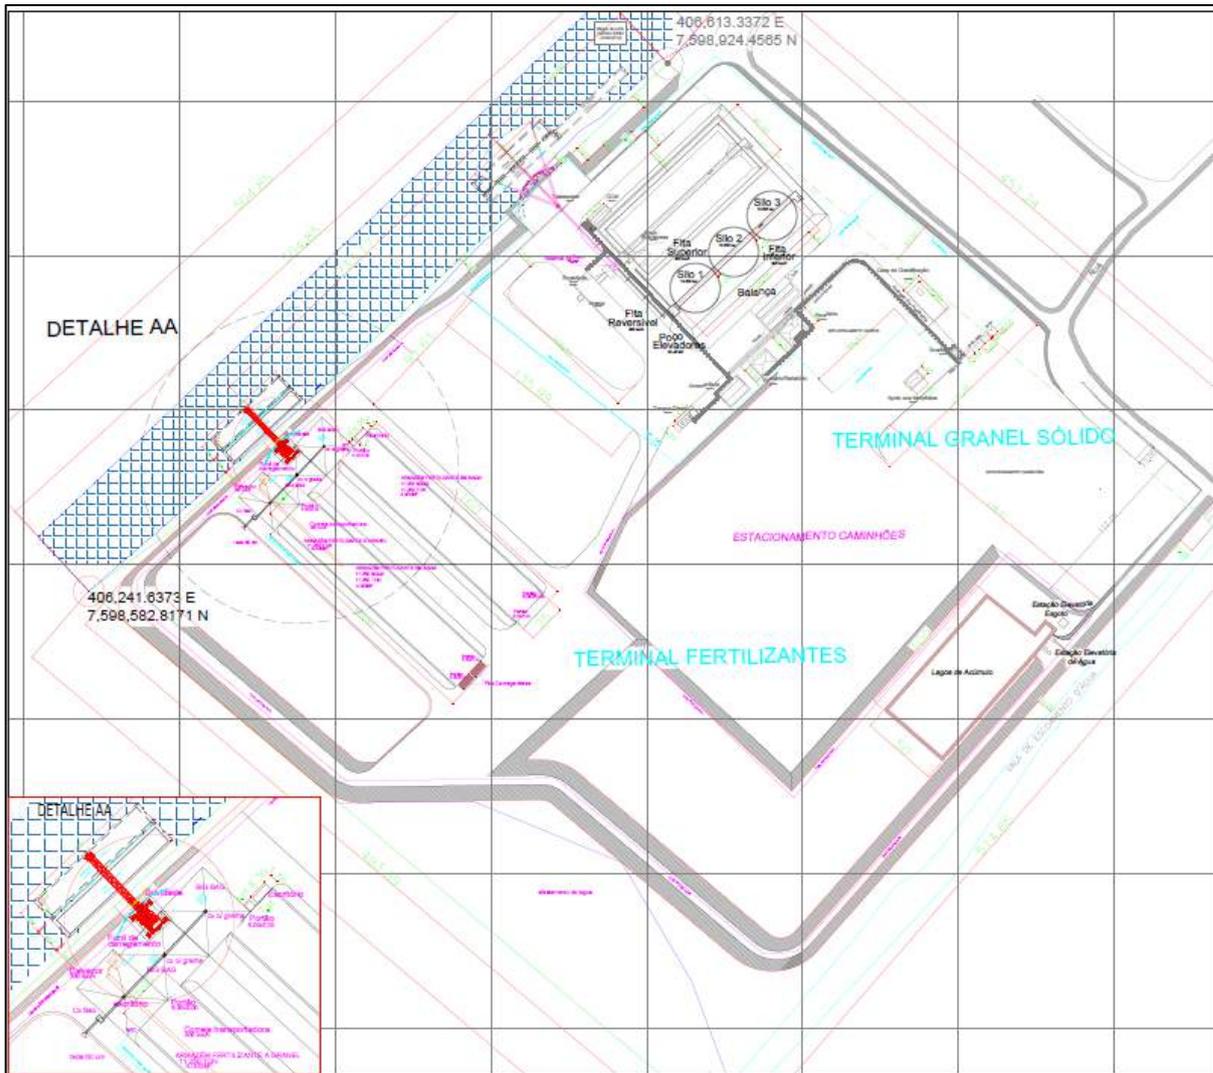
Planta baixa do projeto de execução com a ampliação do Terminal.
